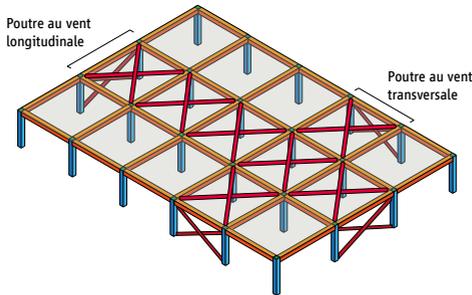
Exemple de contreventement horizontal d'un niveau par 2 poutres au vent
